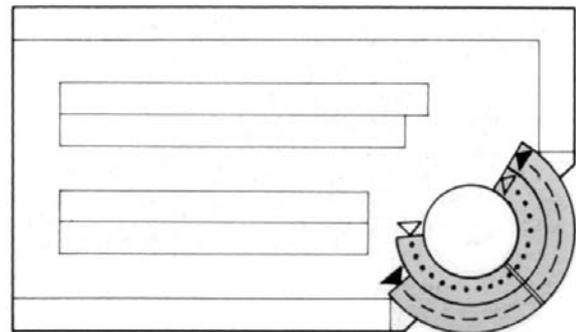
Pavimento tipo do Edifício "Downtown Center"
